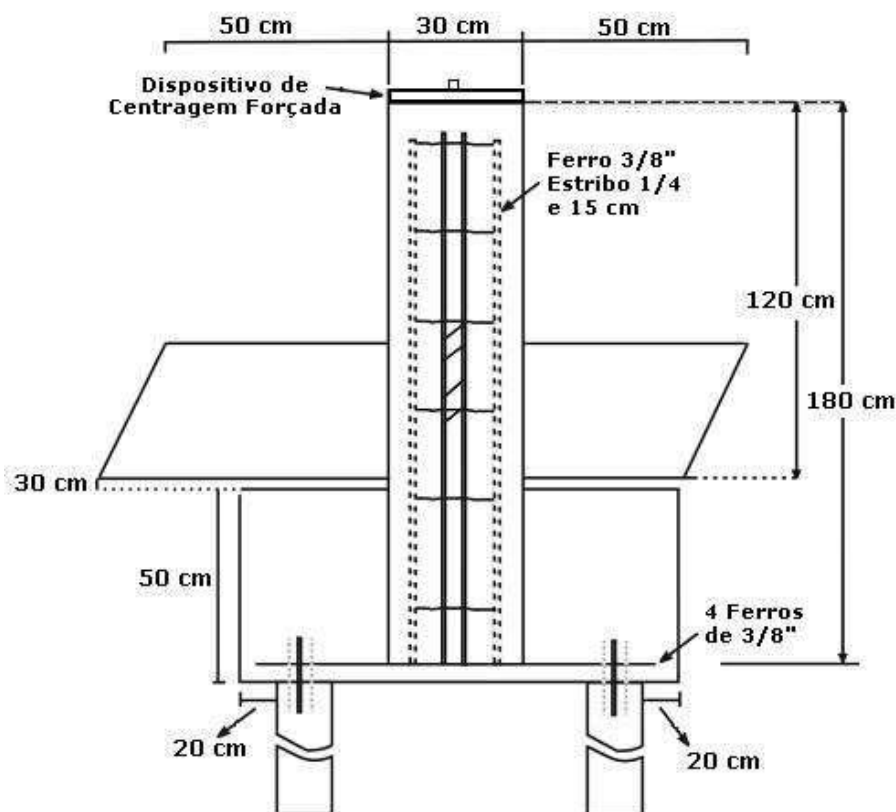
Esquema do pilar de concreto com dispositivo centragem forçada.
